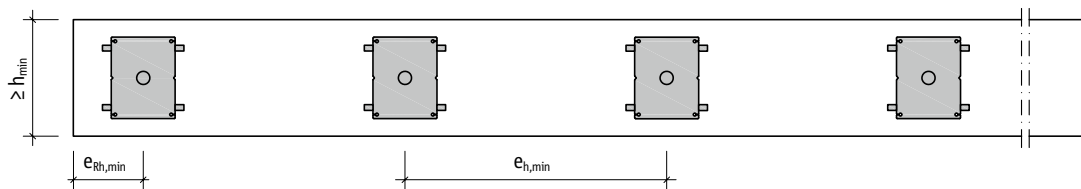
Stacon® SLD: Minimale Bauteilabmessungen und Dornabstände bei einer Platte
